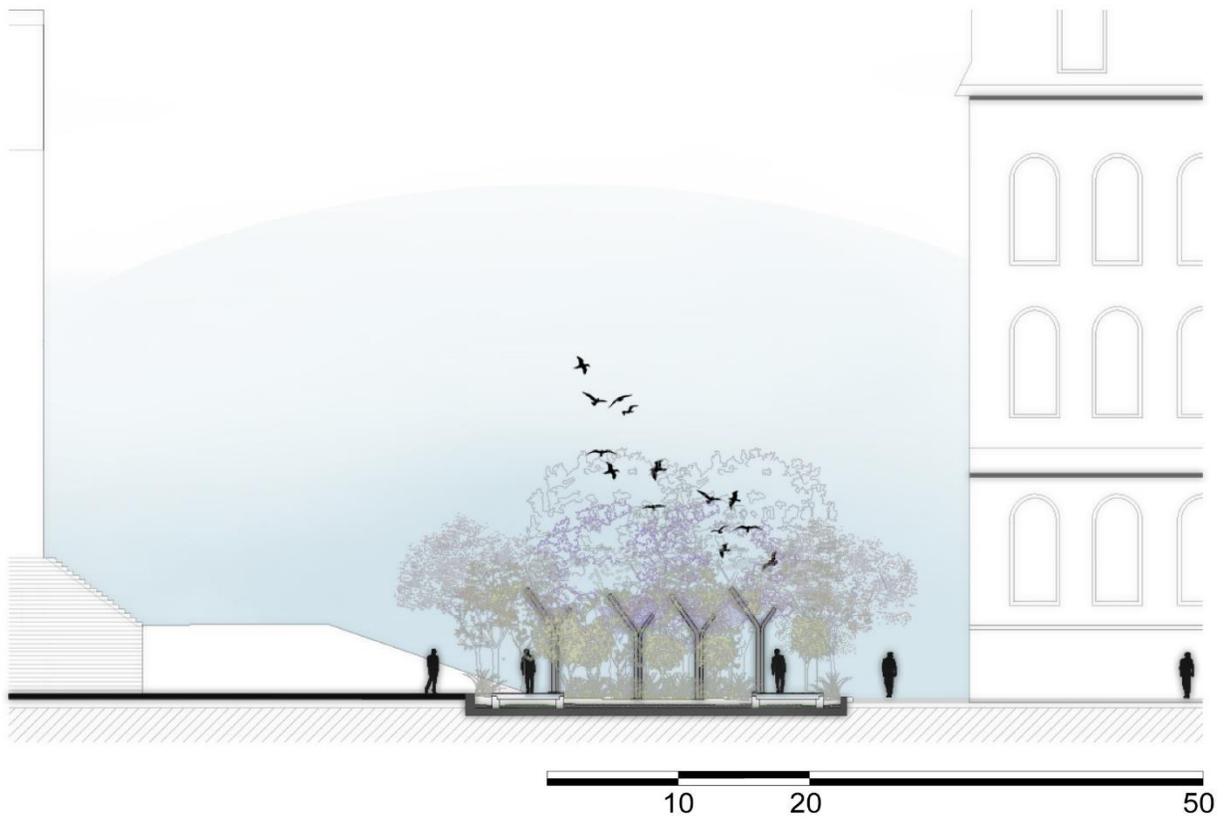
Corte transversal del proyecto "Rambla al Río" sobre la calle Estados Unidos.
